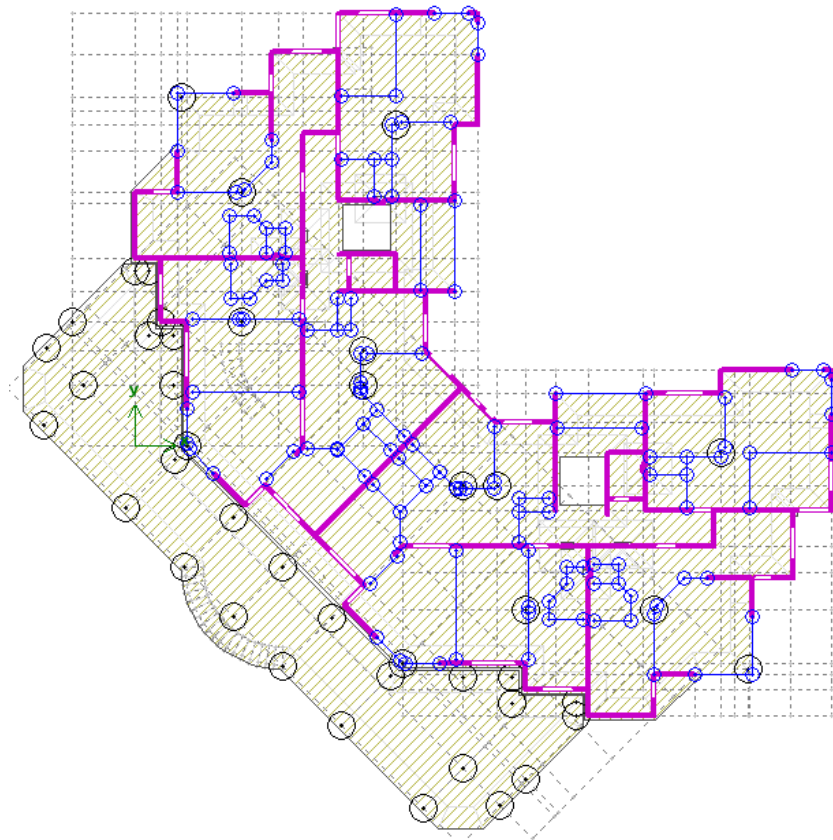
Розрахункова схема будівлі на відмітці +7,200
